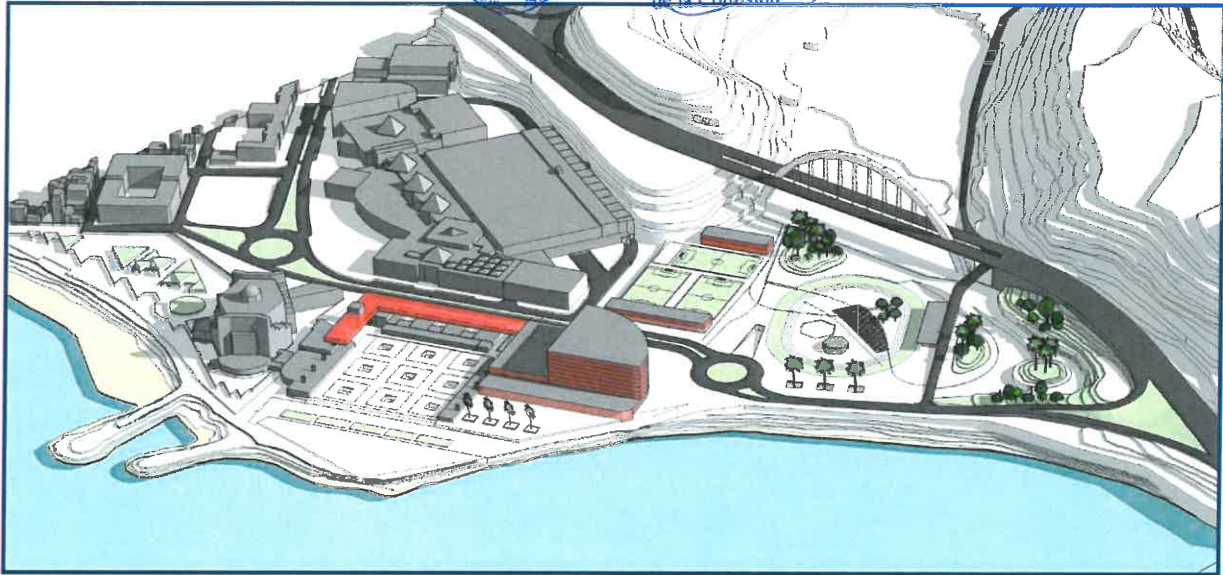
Alternativa 1. Imagen de la volumetría 2. Fuente: elaboración propia
